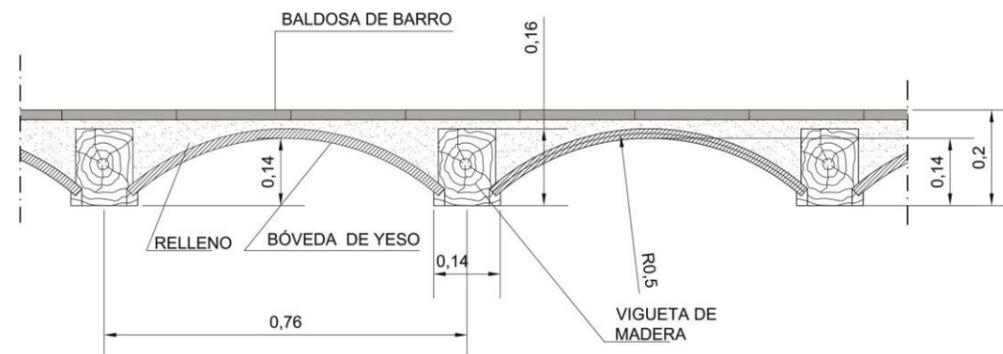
Detalle forjado tipo 2. Fuente: Propia.
